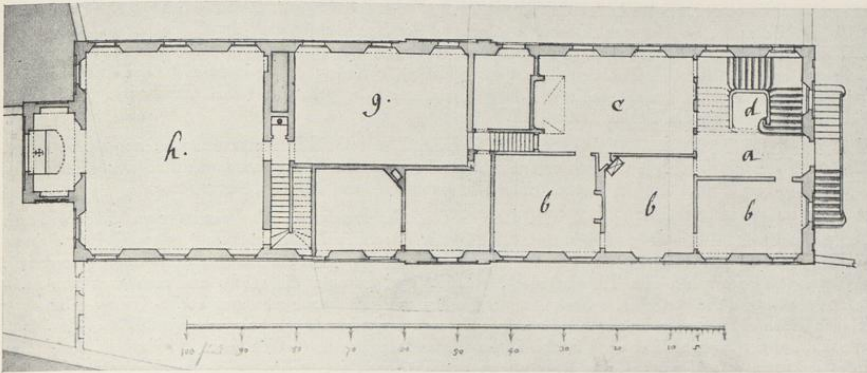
Grundriß des Erdgeschosses des Zuchthauses (erster Entwurf). Norden unten
